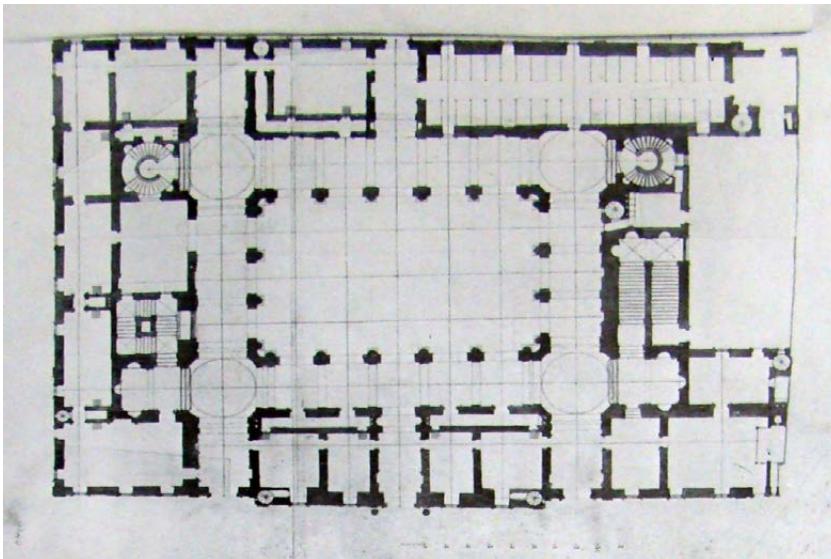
Carlo Fontana. Planimetria del pian terreno del secondo progetto per palazzo Sternberg a Praga (1696-1700) (da HAGER 1977, fig. 309).
